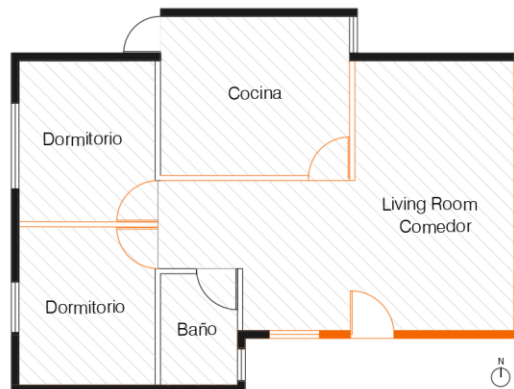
Planta esquemática de modificaciones a la vivienda. Fuente: Elaboración propia.
